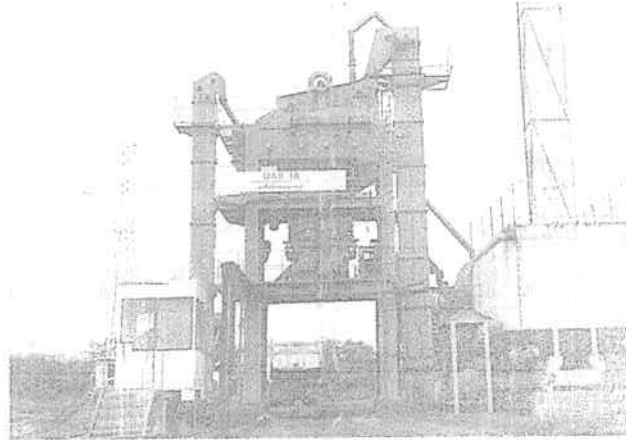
Mezclador y dosificador de asfalto terminado – Planta de asfalto.
